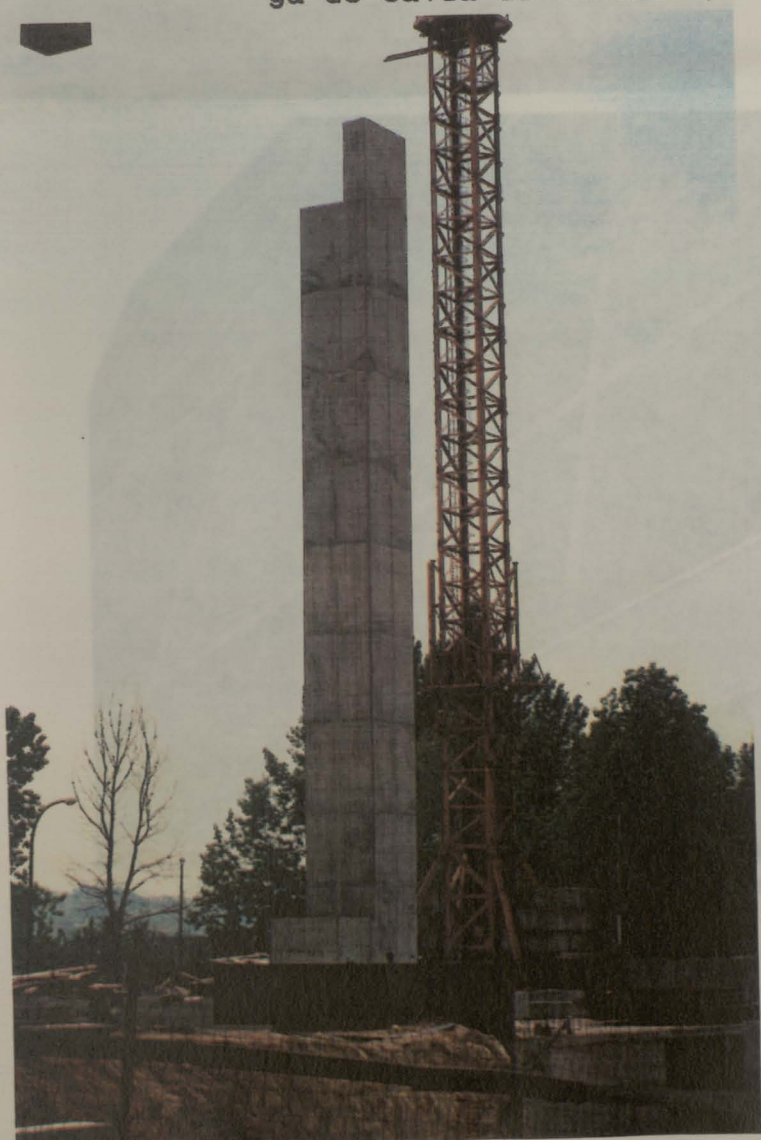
Estrutura em betão armado à vista executada com cofragem de contraplacado
